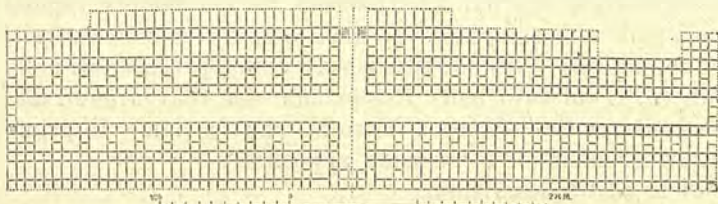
Edificio della Esposizione mondiale di Londra del 1851 nell'Hyde-Park (arch. Paxton).
